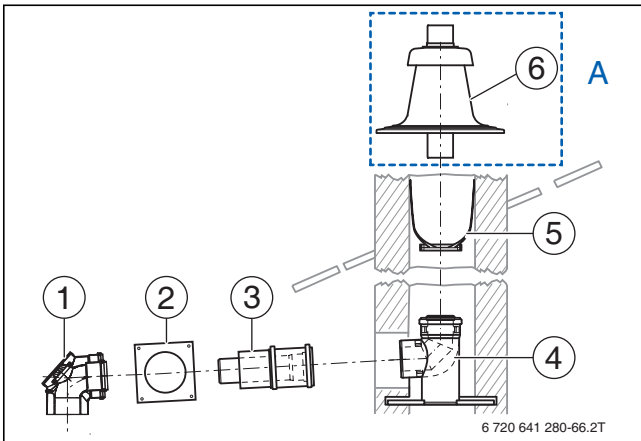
Bauteile Grundbausatz DO-S aus Kunststoff
